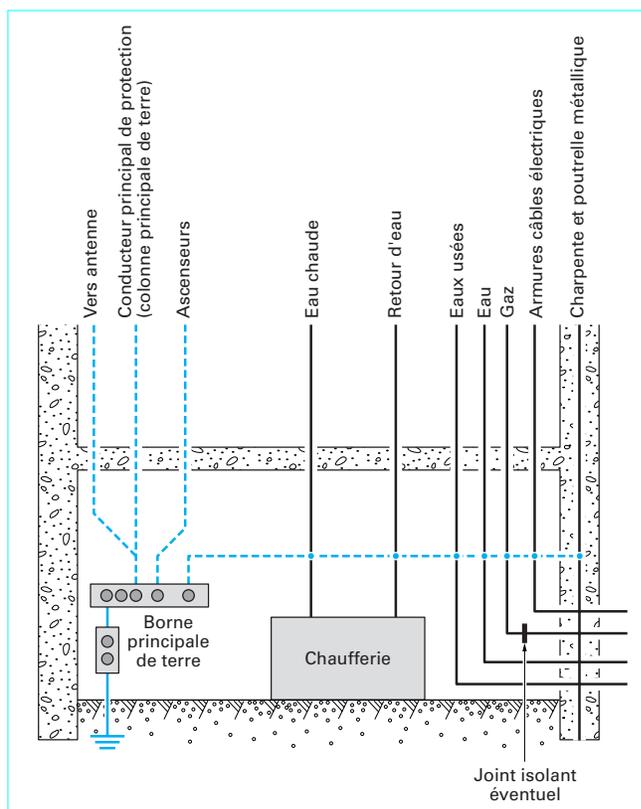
Liaison équipotentielle principale d'un bâtiment collectif [3]
